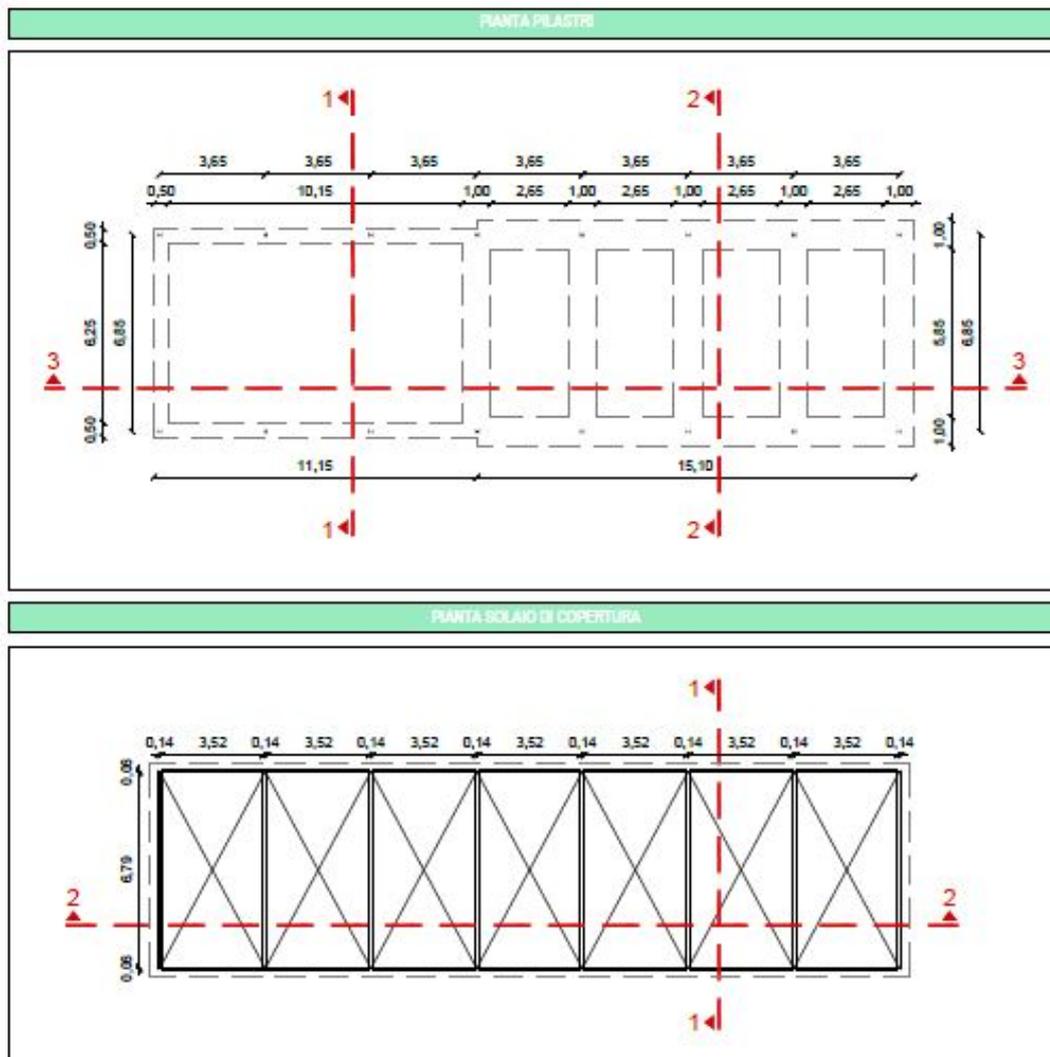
Tettoia cisterne e piazzola di lavaggio: Pianta pilastri e pianta solaio di copertura
